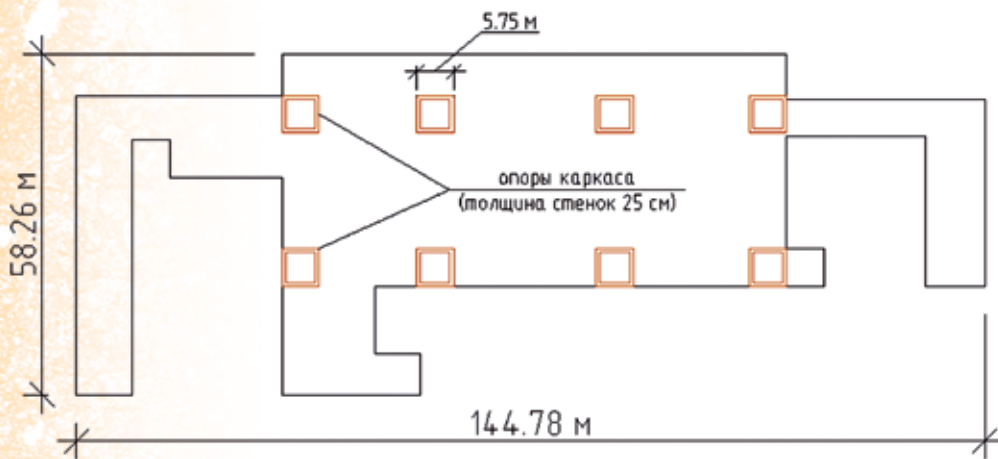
Размещение опор антисейсмического железобетонного каркаса внутри здания вокзала
